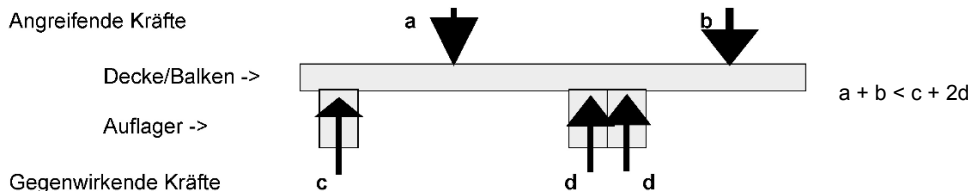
Kräfteschema an einfach ausgewählten Bauteilen
